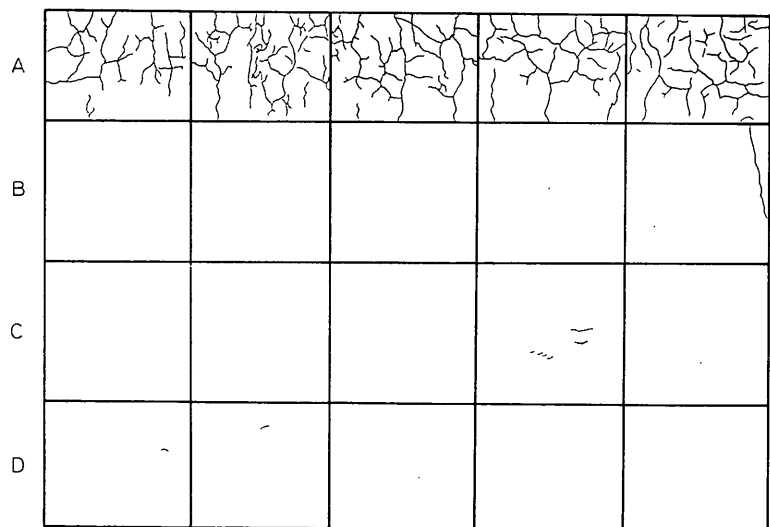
ひびわれ調査図（施工後4ヶ月）
